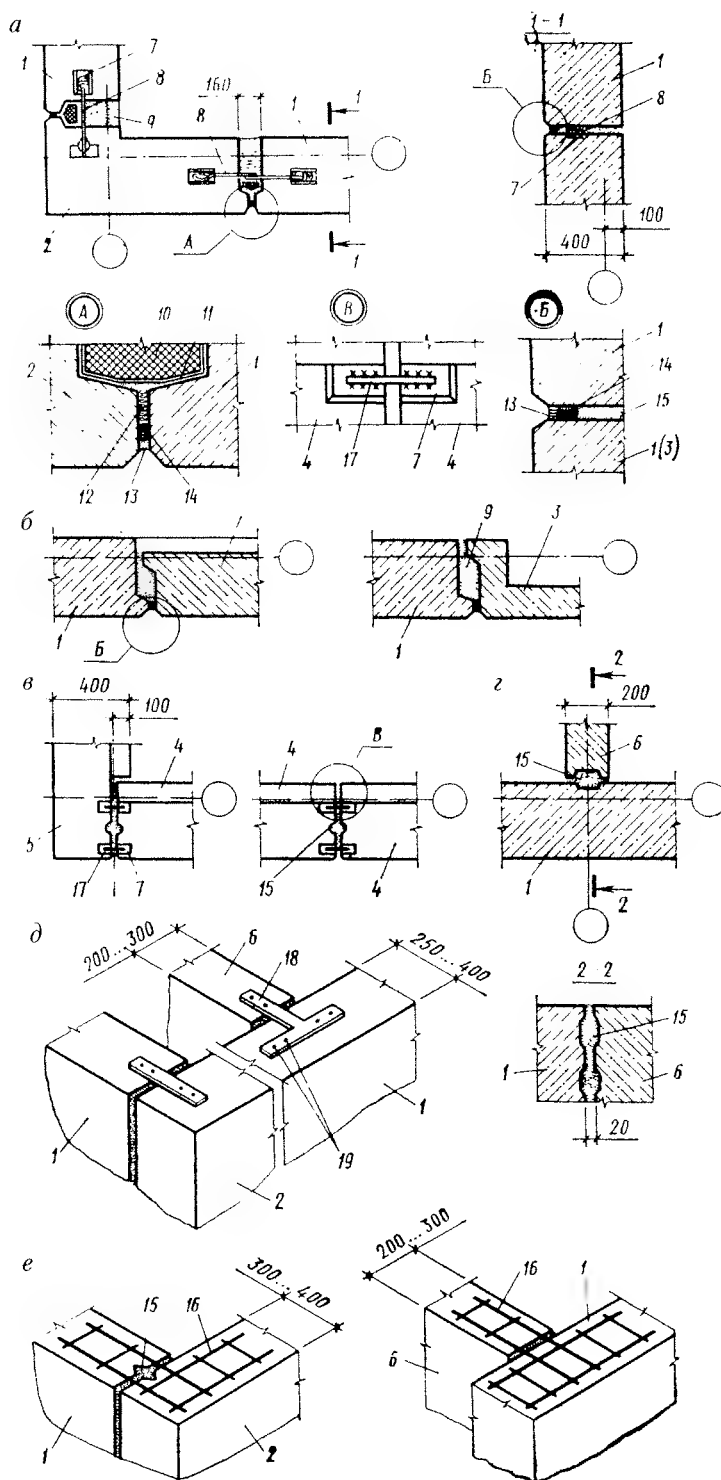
Узлы сопряжений блоков наружных стен:
